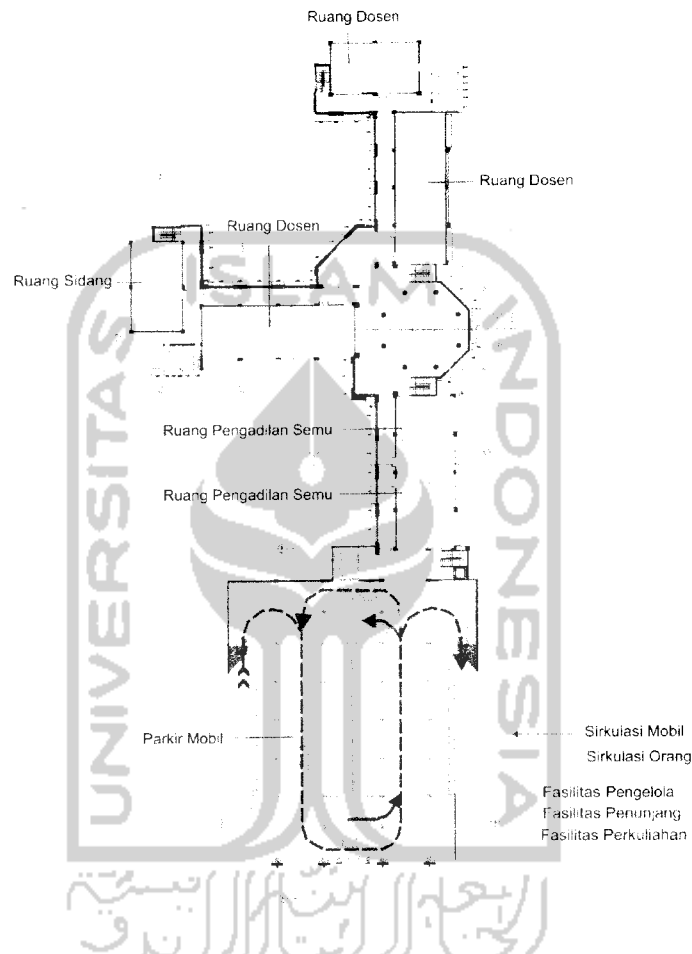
Konsep Organisasi Ruang Lantai 1
